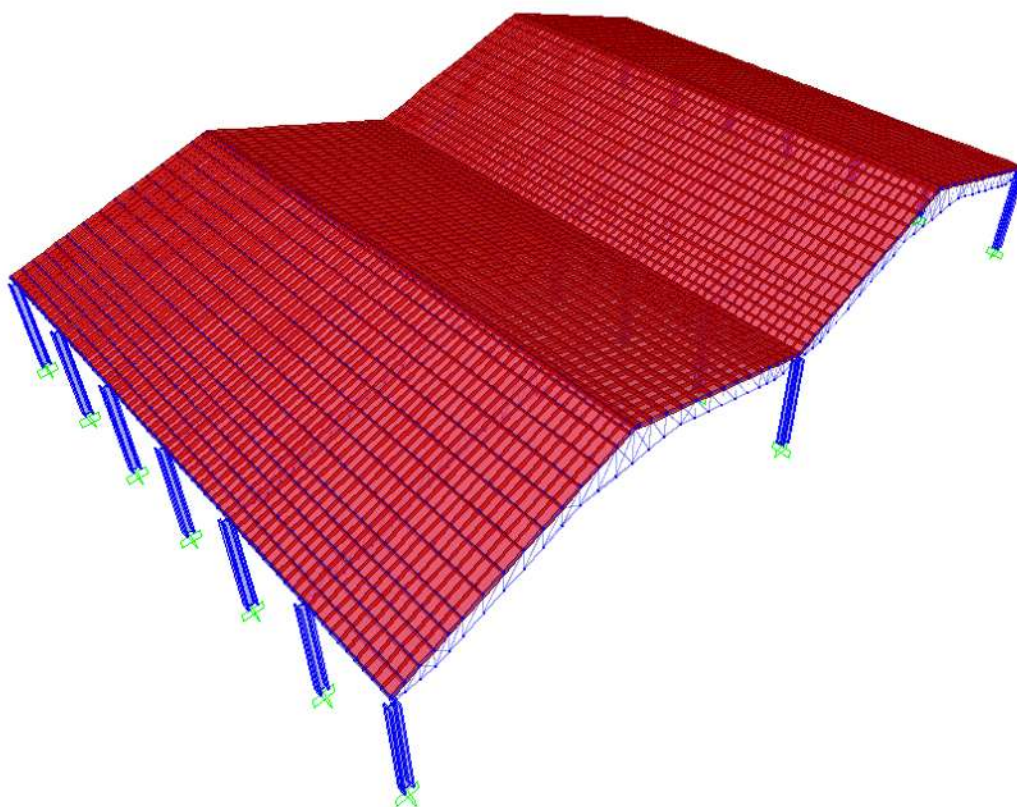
Elementos tipo placa (rojo) y restricciones de apoyo (verde)
